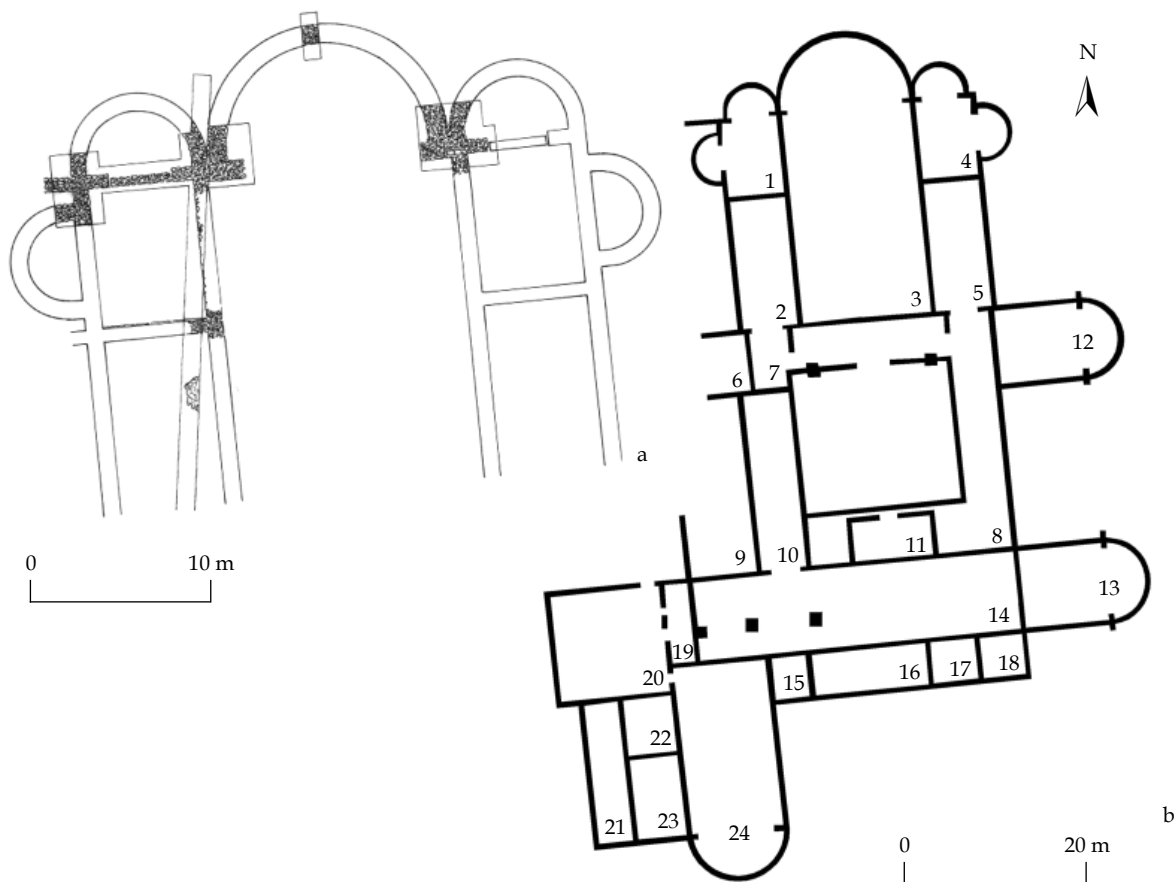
Das Hauptgebäude (Nr. VIII) der Festung von Alsóheténypuszta: a mit den Grabungsschnitten und dem anhand deren rekonstruierten Grundriss des nördlichen Teils; b Rekonstruierter Grundriss mit Nummern der einzelnen Räumlichkeiten (s. dazu Text). – Foto: Autor.
